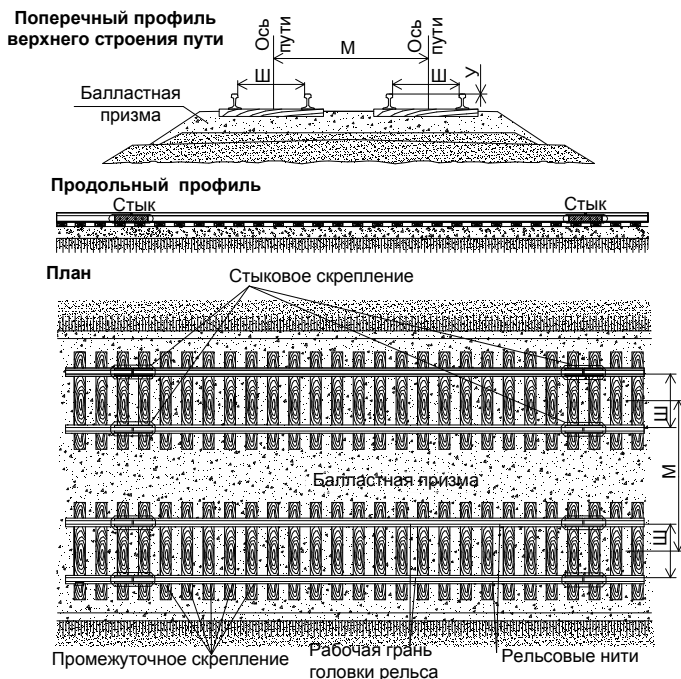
Поперечный и продольный профили, план верхнего строения прямого участка железнодорожного пути на деревянных шпалах
